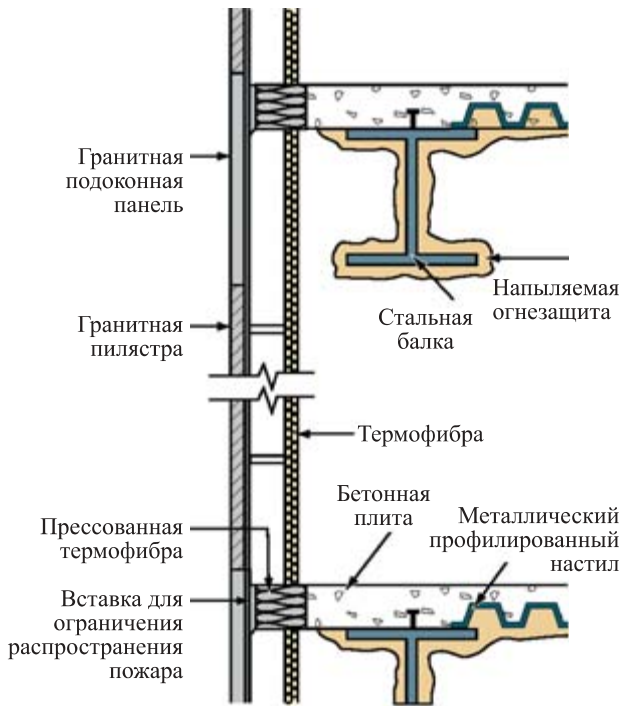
Конструкция междуэтажного перекрытия и ограждающих конструкций с элементами огнезащиты стальных конструкций здания ВТЦ-7
